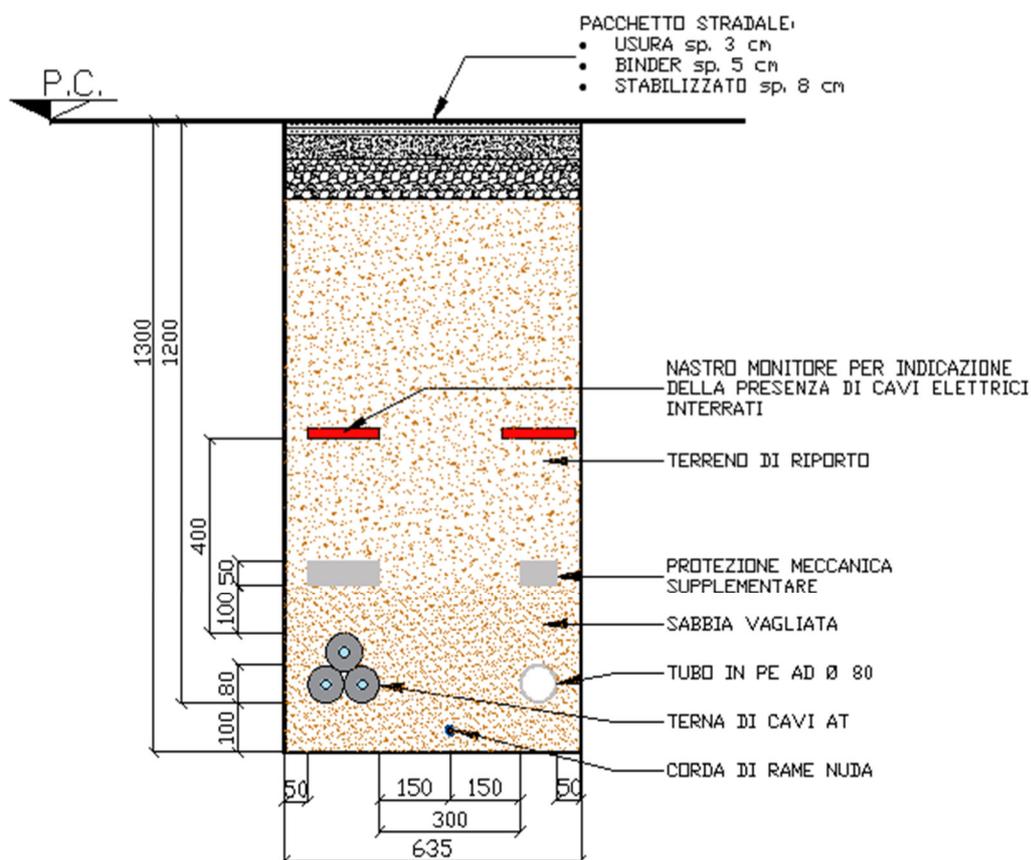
Sezione tipo posa cavidotti per le linee MT e 36 kV
